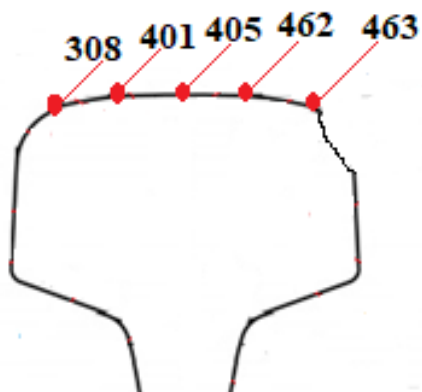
Измерение твердости металла (в кривой R = 1307 м) на поверхности катания шлифованного рельса ENSIDESA 02 14 60 E1
